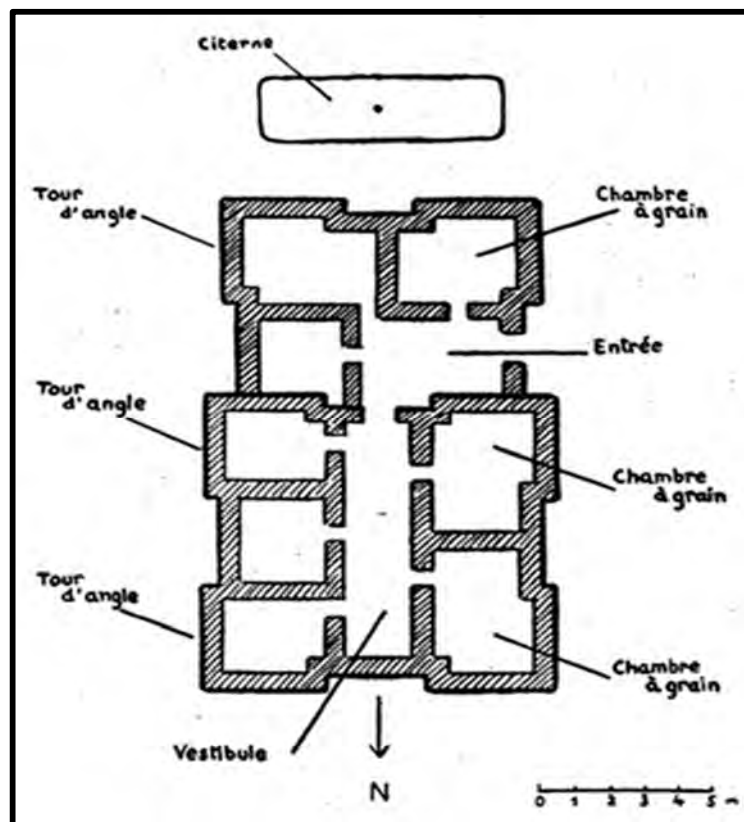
Irherm n'Ait Ydir (Tribu Ait Abas) 4 étages, -23 chambres- Plan du rez-de-chaussée . - (La partie sud du bâtiment a été construite lorsque le magasin est devenu trop petit pour la fraction).
